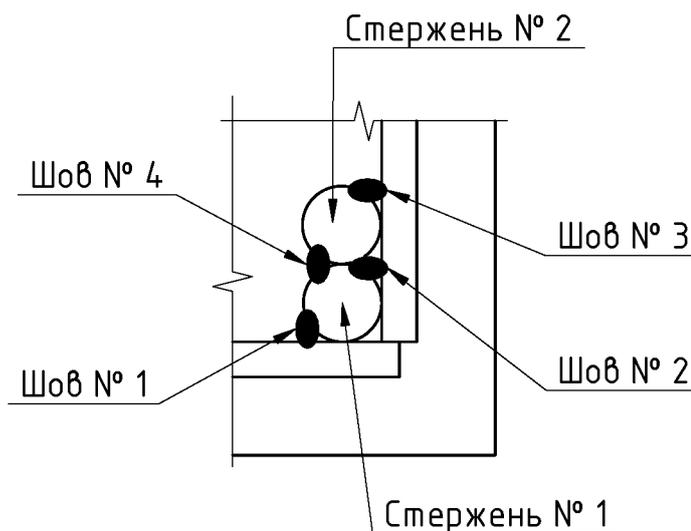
Схема приварки арматурных стержней к закладным деталям М5
